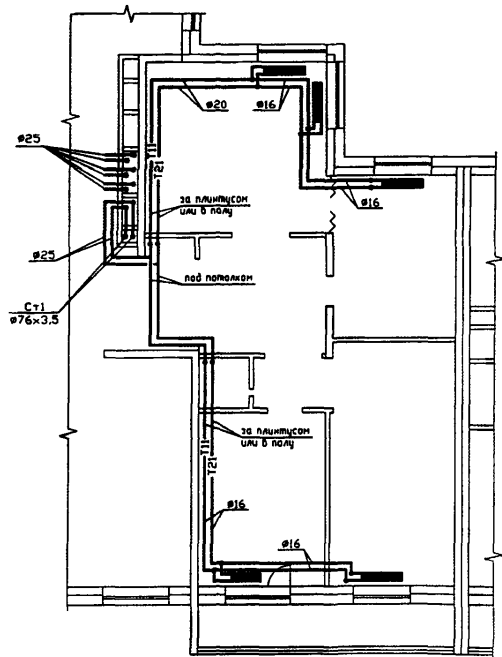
Система отопления с плинтусной разводкой теплопроводов по квартире
